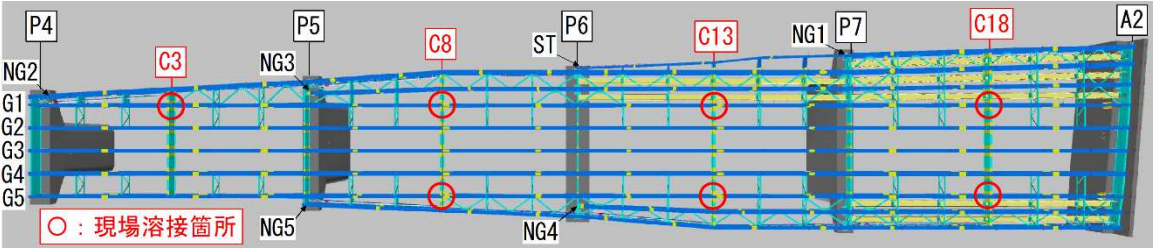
久慈大橋分配横桁仕口の現場溶接箇所（平面図）
